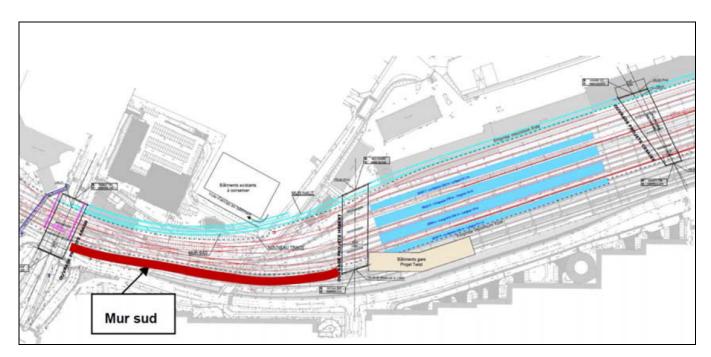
Plan de situation du mur de soutènement situé au sud de la RD 914
